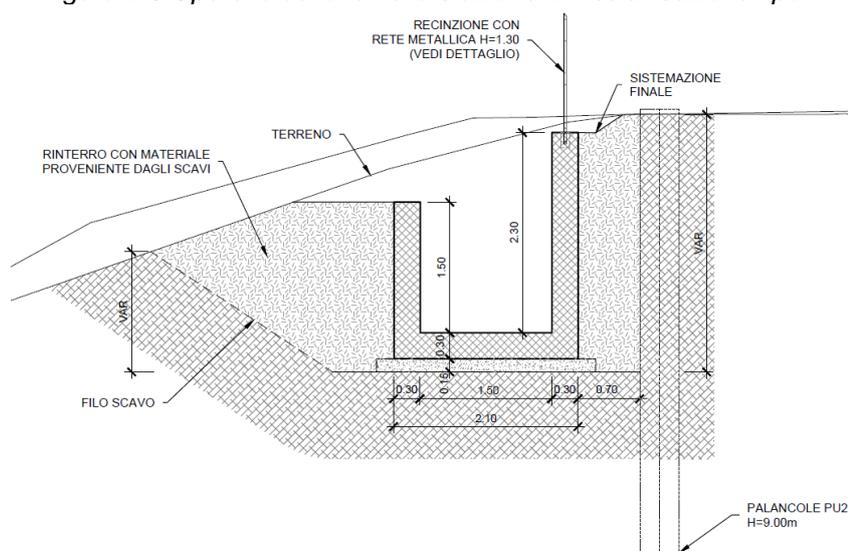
Opere idrauliche nella stazione di Assisi: sezione tipo B
